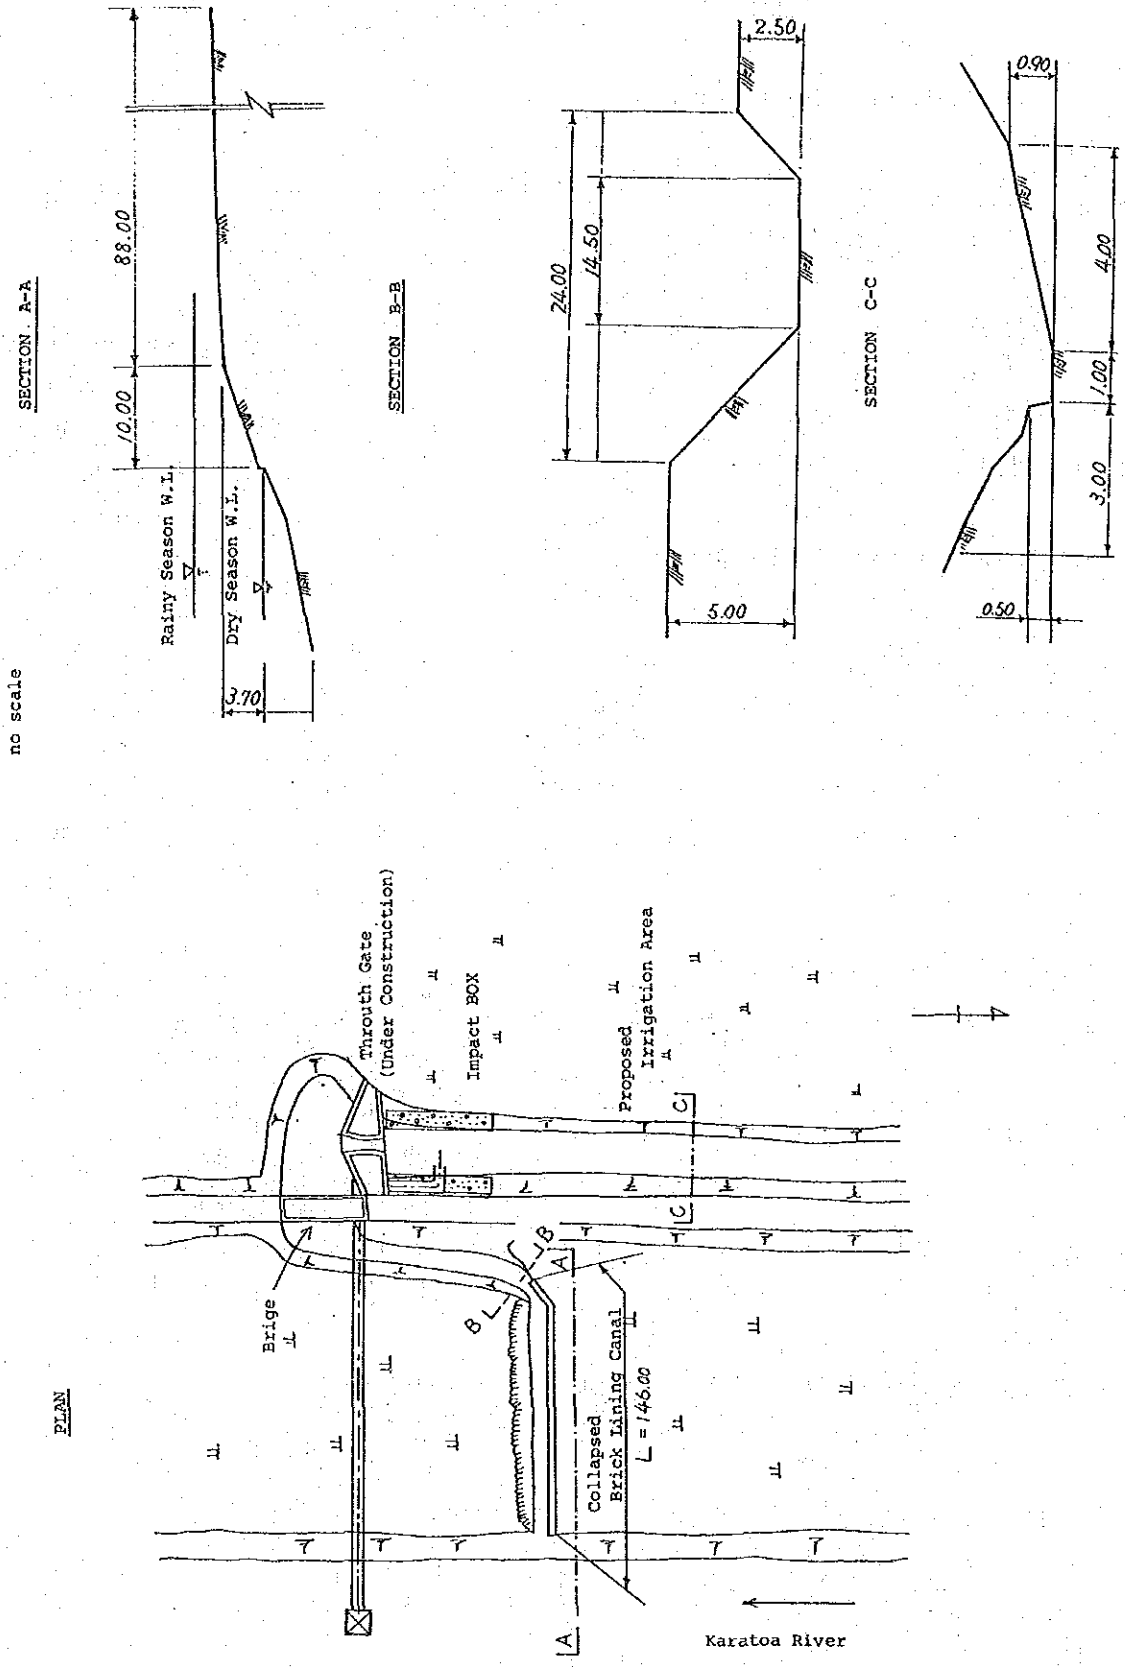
3 SHAHJADPUR UPA-ZILA, SANTHIA 概况 - 平面图
